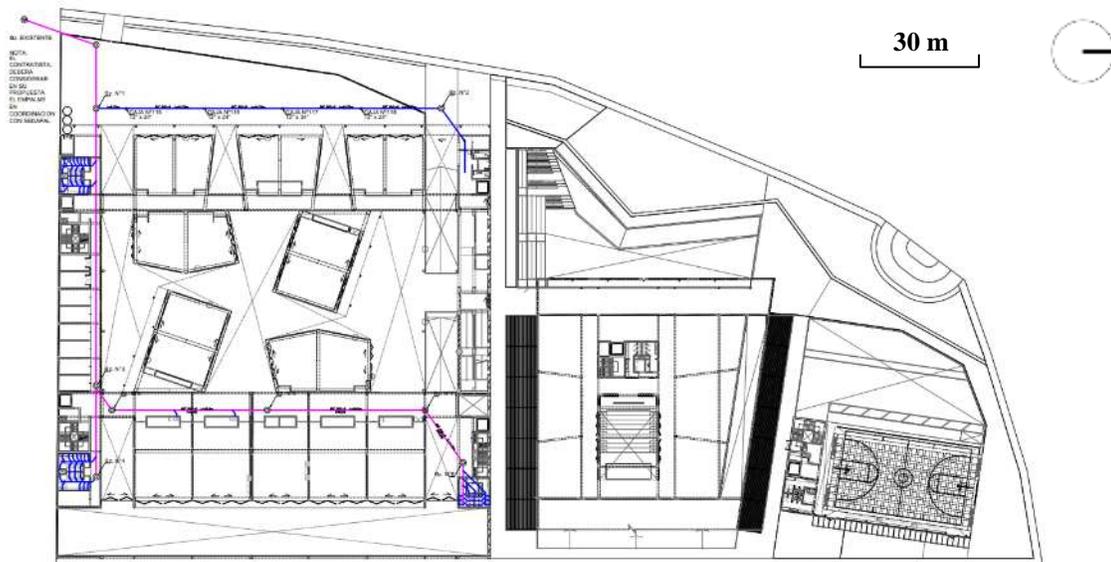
Desagüe, planta del primer nivel. Elaboración propia.
